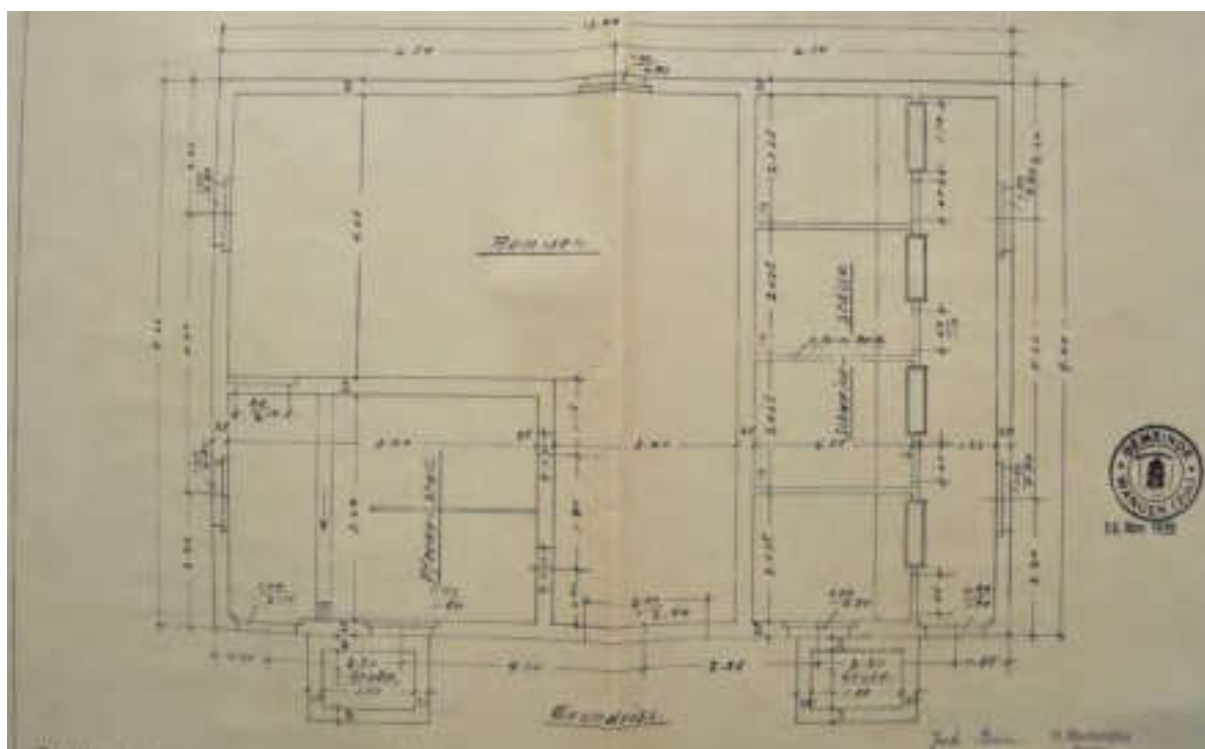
Baueingabeplan Ökonomiegebäude Assek.-Nr. 350, Grundriss 1:50, 25.09.1939, Markwalder Baubüro. Quelle: GdeA.
